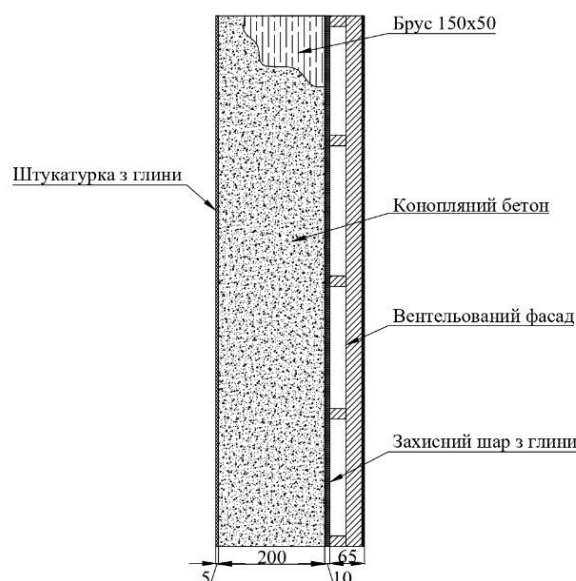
Схематичне улаштування зовнішньої стіни будівлі з конопляного бетону
